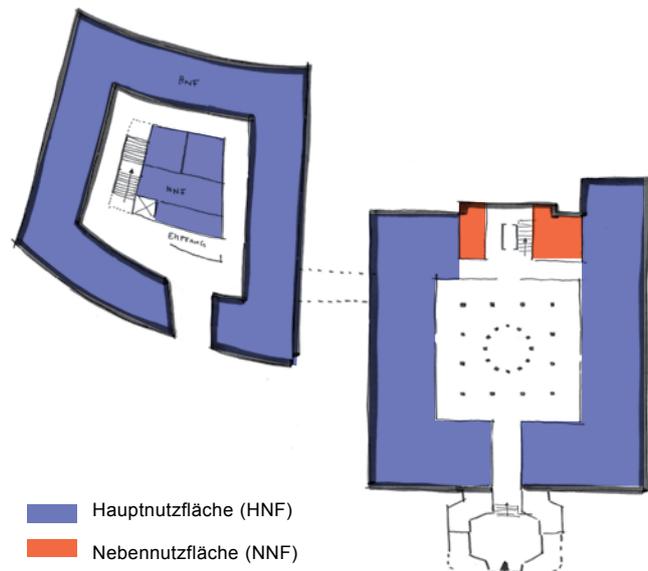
Schema-Grundriss Medico Palais mit Anbau - EG
